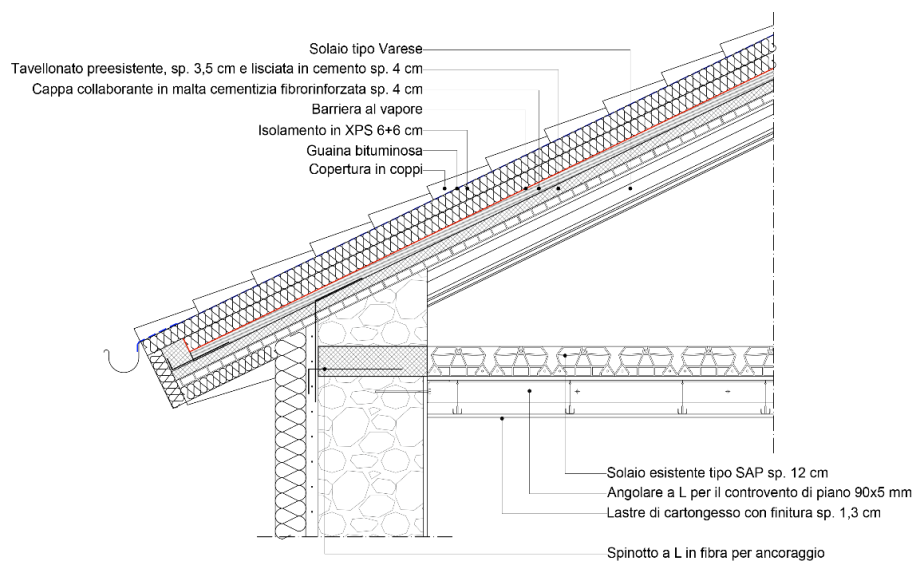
Dettaglio in sezione degli interventi di consolidamento mediante cappa collaborante sulla copertura.
